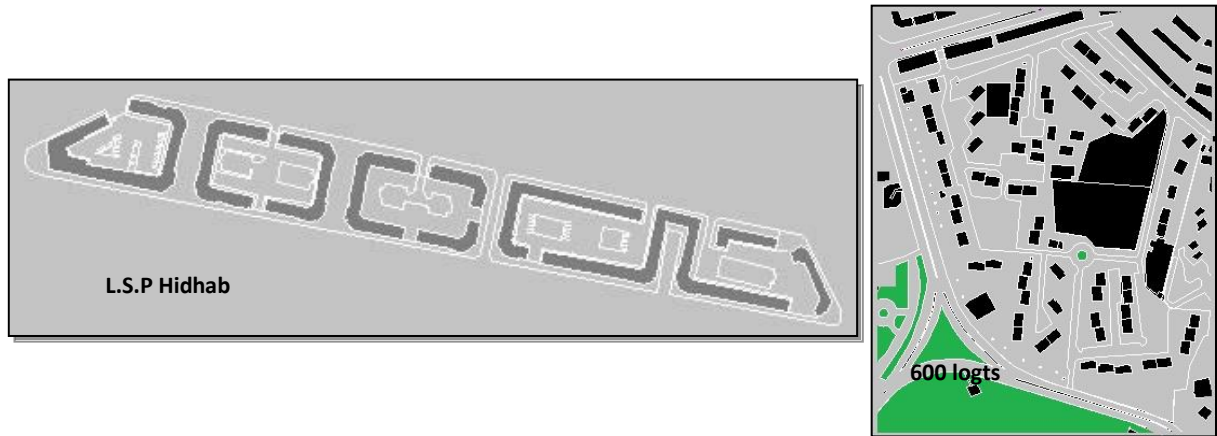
Plans de masse des cas d'étude. (Source: Auteure, 2018)
